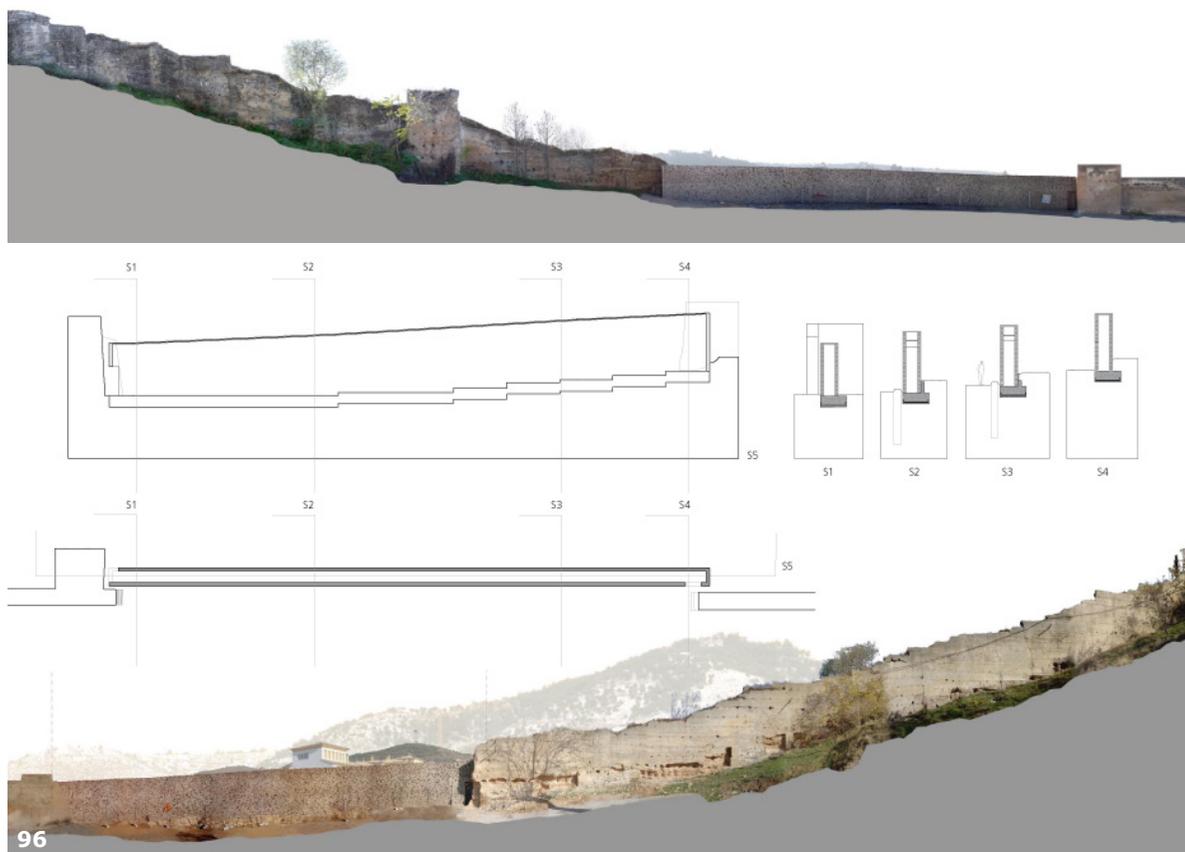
Planos de la intervención: Alzado norte, sección longitudinal, secciones transversales, planta y alzado sur. (R&R nº101, pp. 38-39)
